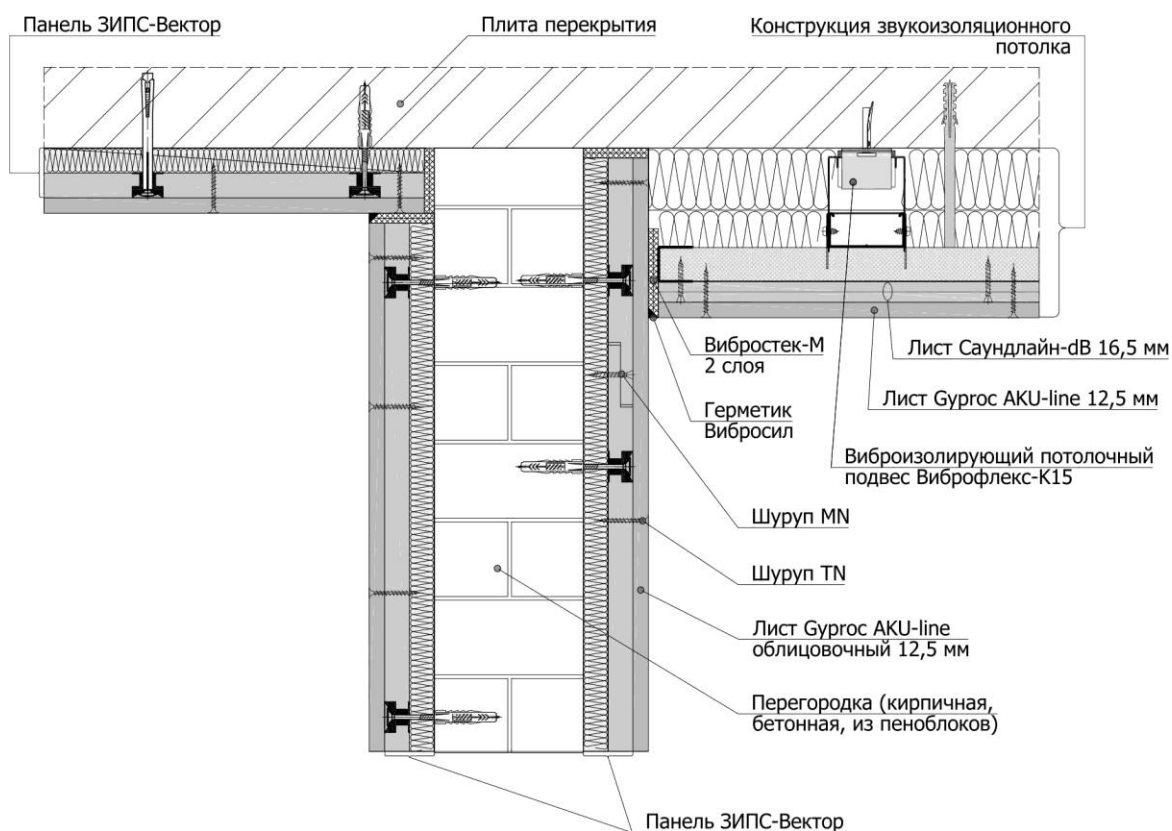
Примыкание бескаркасной звукоизоляции к перекрытию пола/потолка
